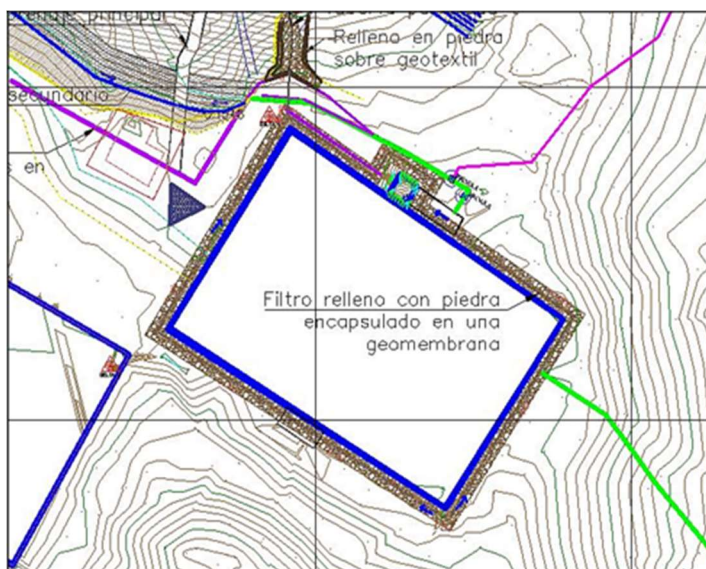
localizacion en planta del filtro recomendado: Elaboración propia.
